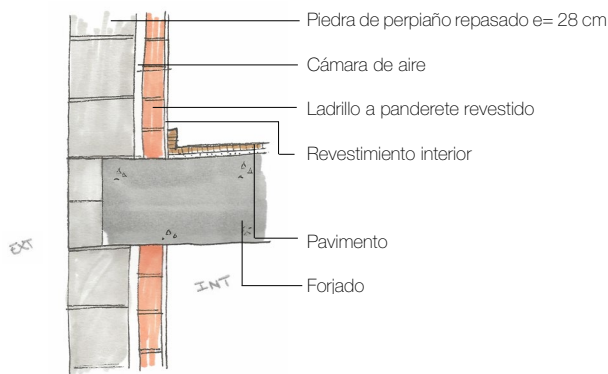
Encuentro forjado con cerramiento (autoría propia).
